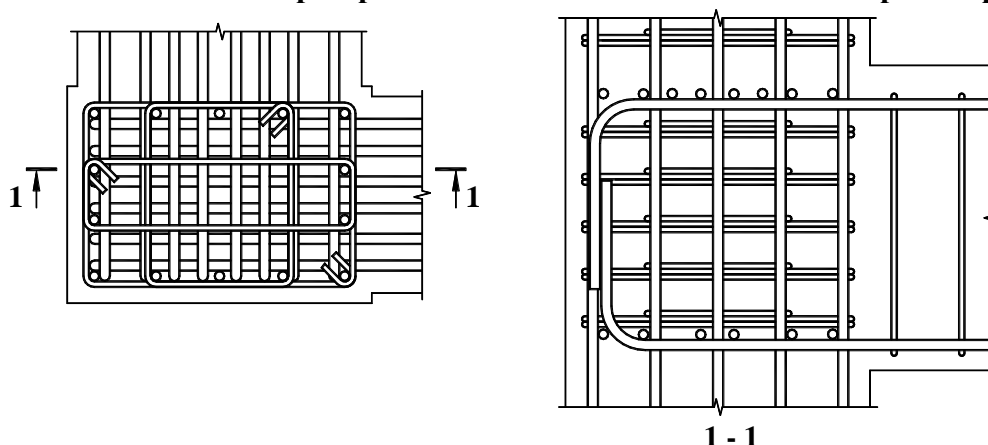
Принципиальная схема армирования соединения балка-колонна при примыкании балок к колонне с двух сторон
